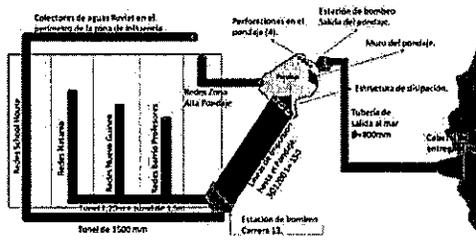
Esquema del componente alcantarillado pluvial SAI.
